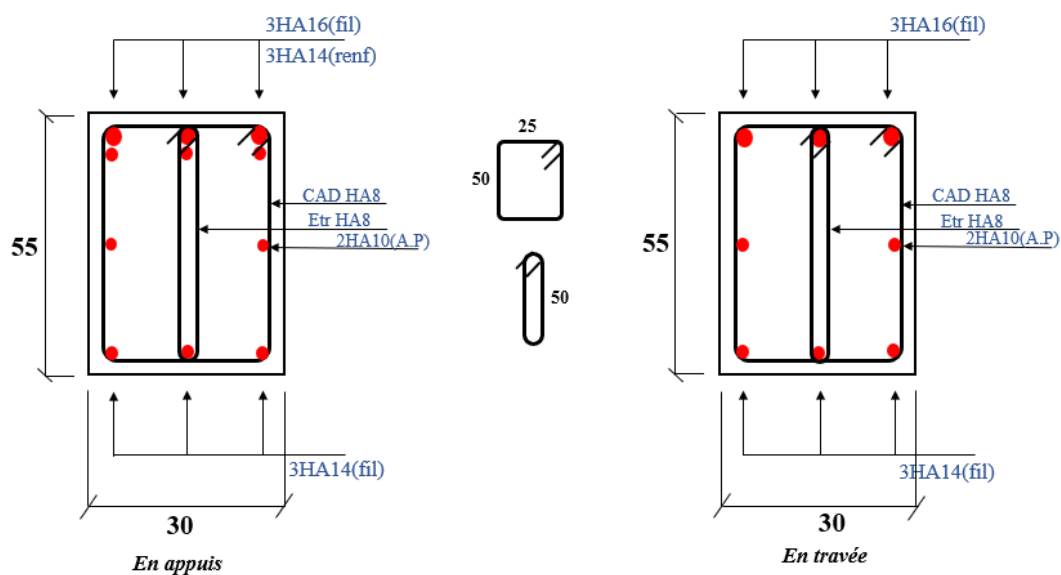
22:Schéma de ferrailage de la poutre (30x55) en appuis et en travée
